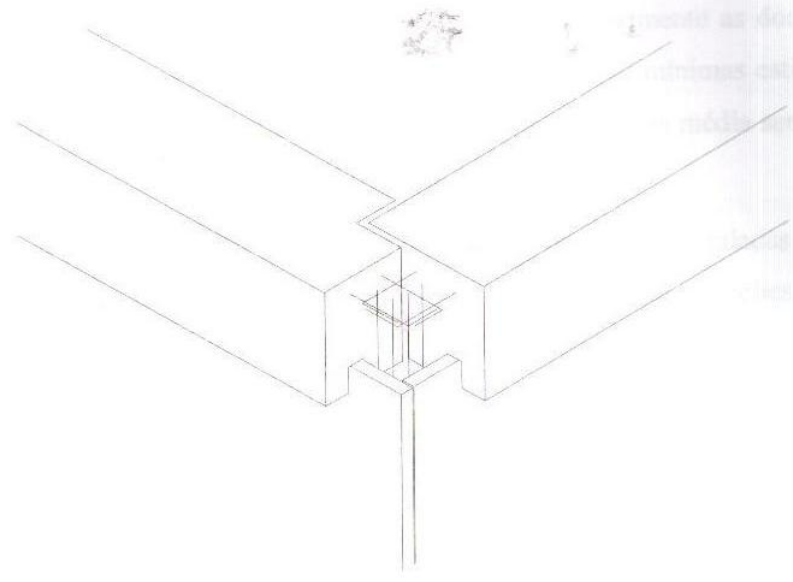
Armadura na viga de cobertura - perspectiva
